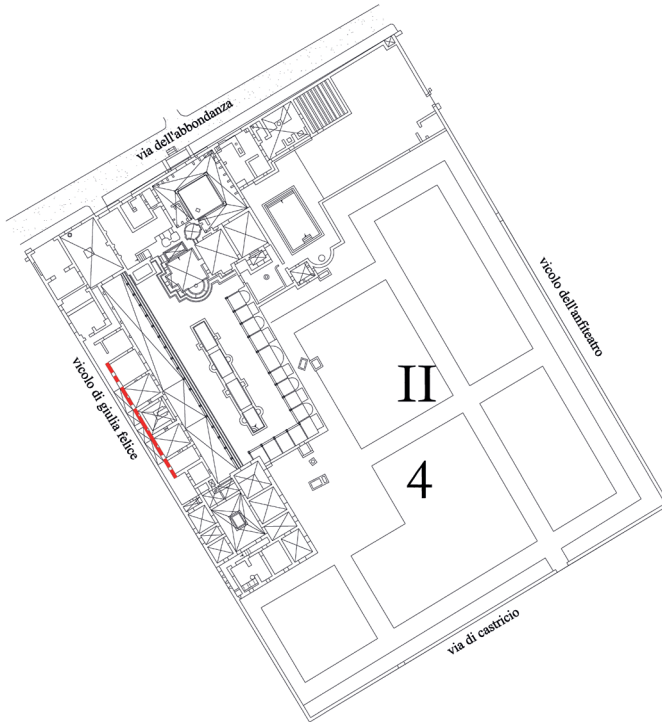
Villa di Giulia Felice con campita in rosso la parete 53 Est oggetto di studio.
